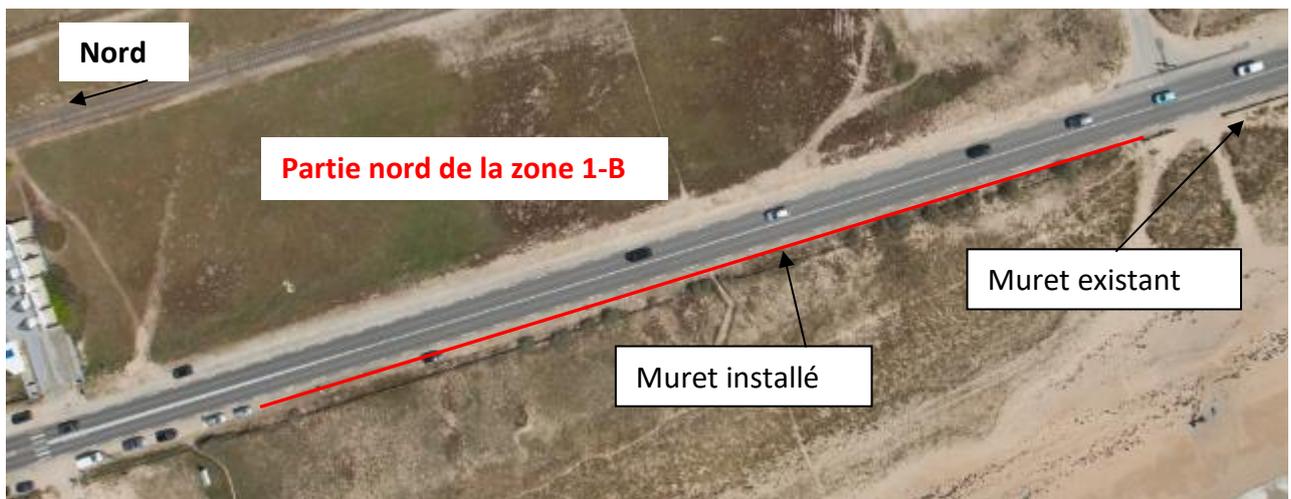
Localisation du muret installé (photo : Auteurs de vues)
